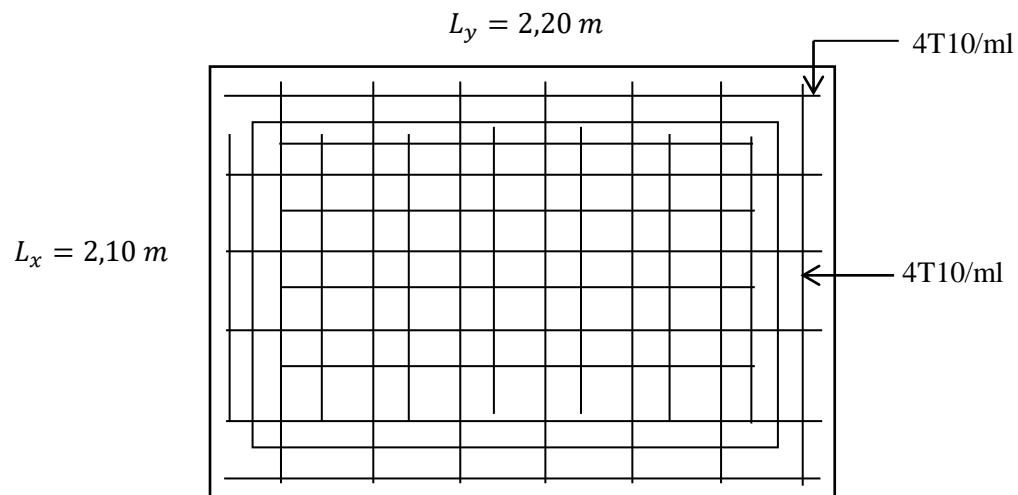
Ferrailage inférieur de la dalle de l'ascenseur
